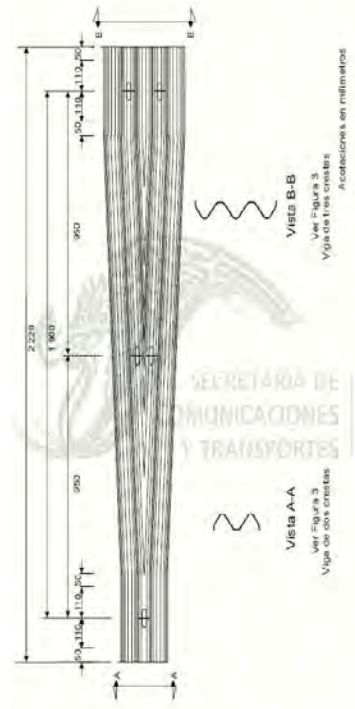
Sección de transición para unir vigas acanalladas de dos y de tres crestas
